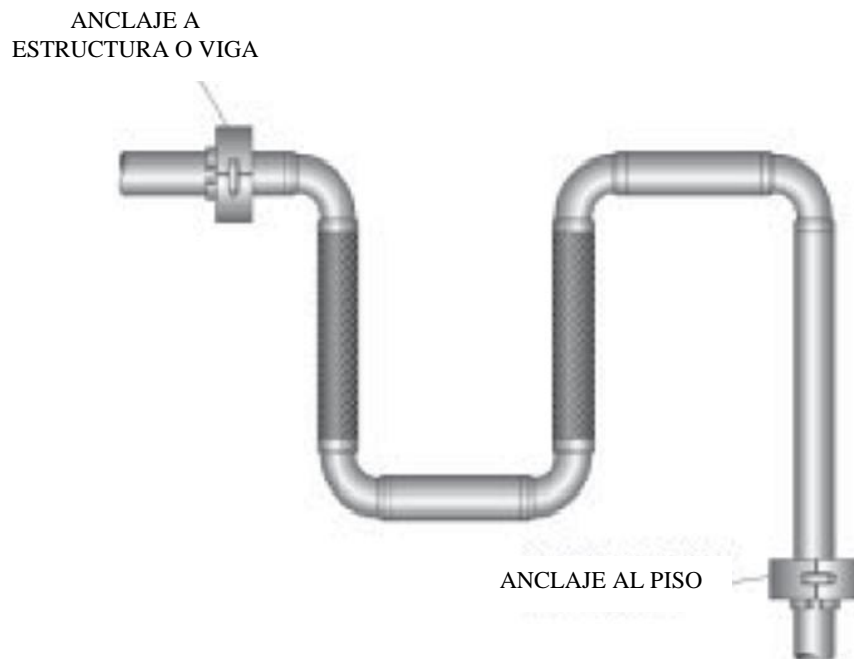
Conexión flexible entre tuberías (FEMA 414)
